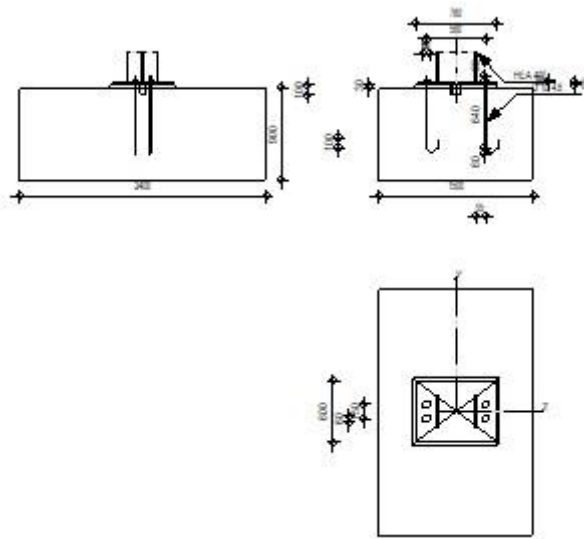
Détail de l'assemblage au niveau du pied de poteau
